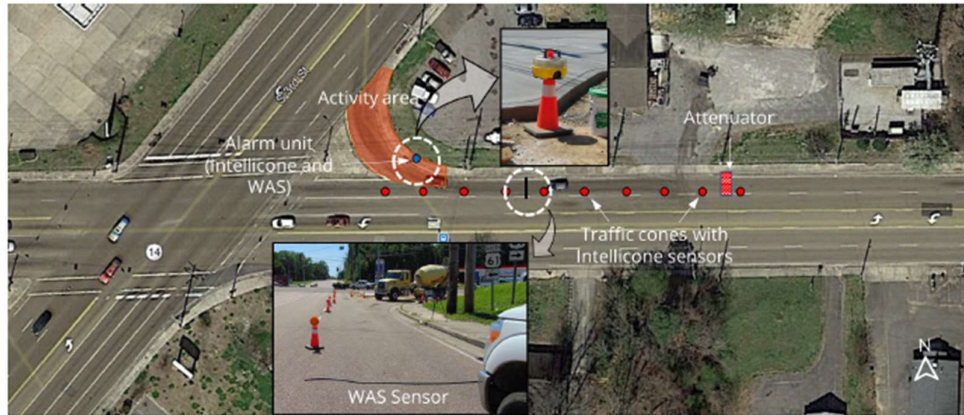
Installazione nell'area di cantiere dei sistemi Intellicone e WAS_ Quinta configurazione di cantiere
